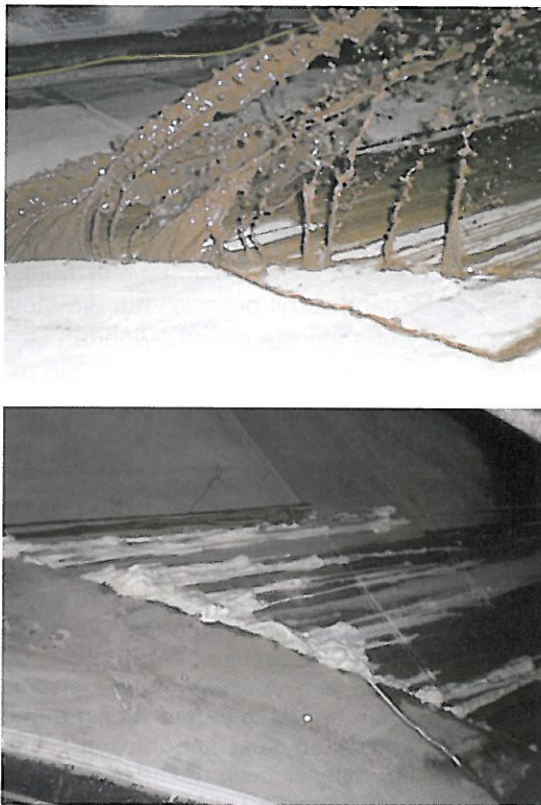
Unter Druck wasserführende Ringfuge zwischen Tübbingtunnel und Stahlbetonwand vor (oben) und 30 Minuten nach (unten) der Injektion mit PUR-Schaum.
